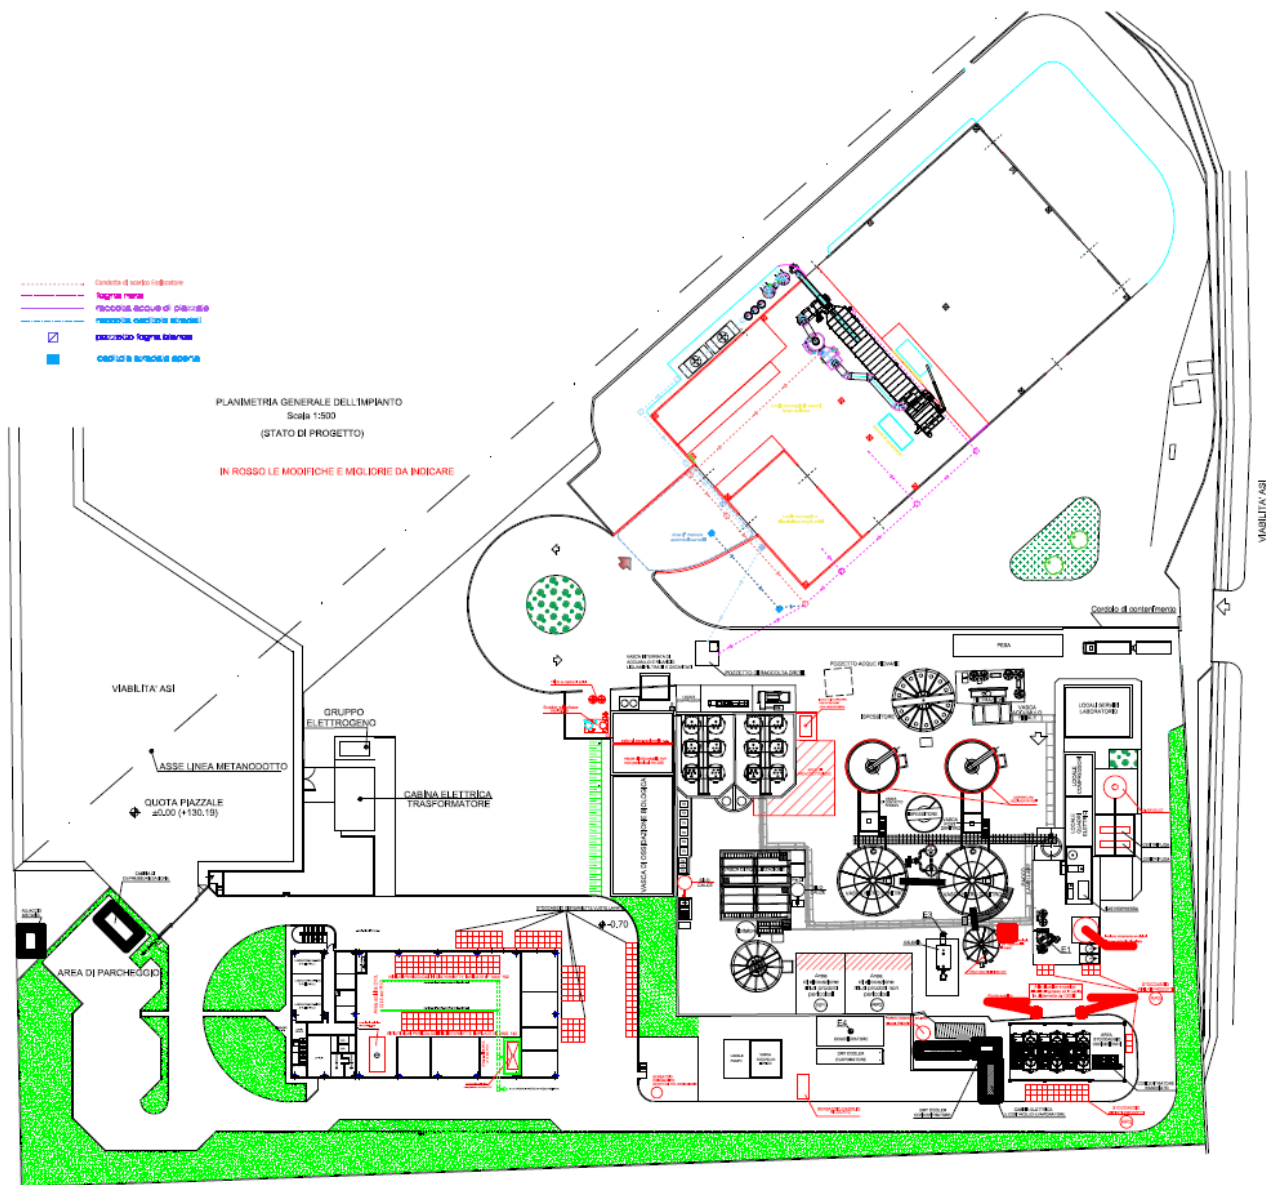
Planimetria Generale del complesso SANAV S.r.l.
